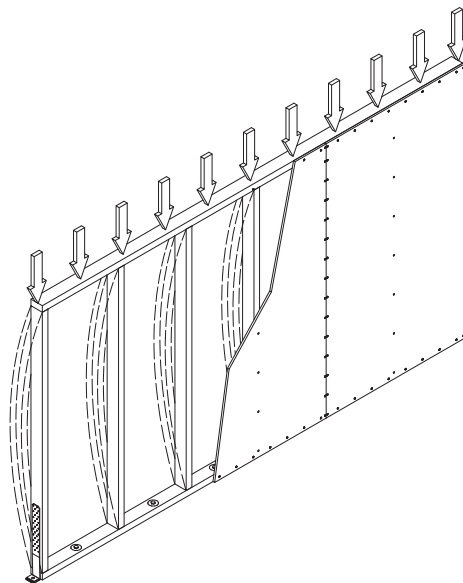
Parete Platform soggetta a carichi verticali. La resistenza è devoluta ai montanti verticali che si possono instabilizzare solo nel piano ortogonale alla parete, in quanto l'instabilizzazione nel piano della parete è impedita dai pannelli di rivestimento strutturale.
